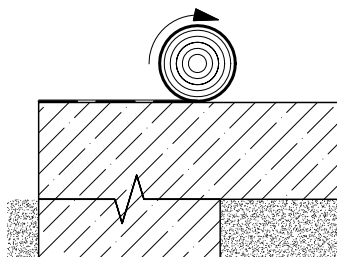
Auf der Bodenplatte wird auf ganzer Fläche eine Abdichtung nach DIN 18533-2 verlegt, als Sperre gegen aufsteigende Feuchte. Ausführung: z. B. Bitumen-Schweißbahn G 200 S4.
